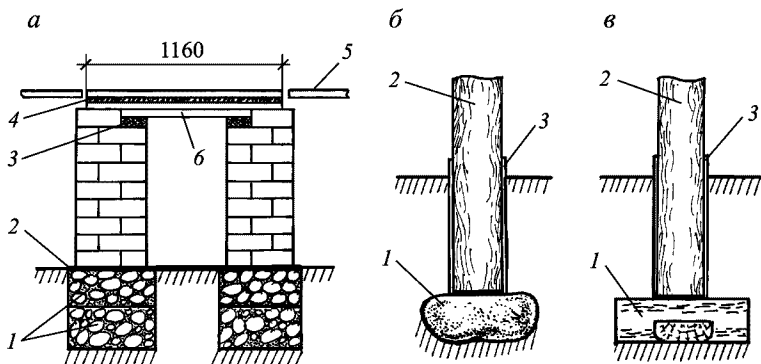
Столбчатый фундамент из кирпича и деревянные стулья:
